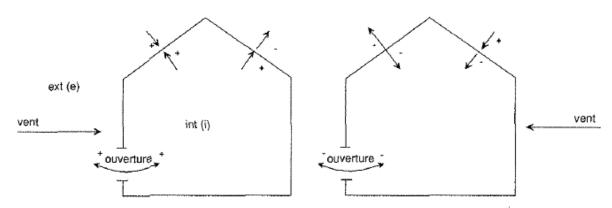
Pression du vent sur les versants d'une toiture (- : dépression, + : surpression).
